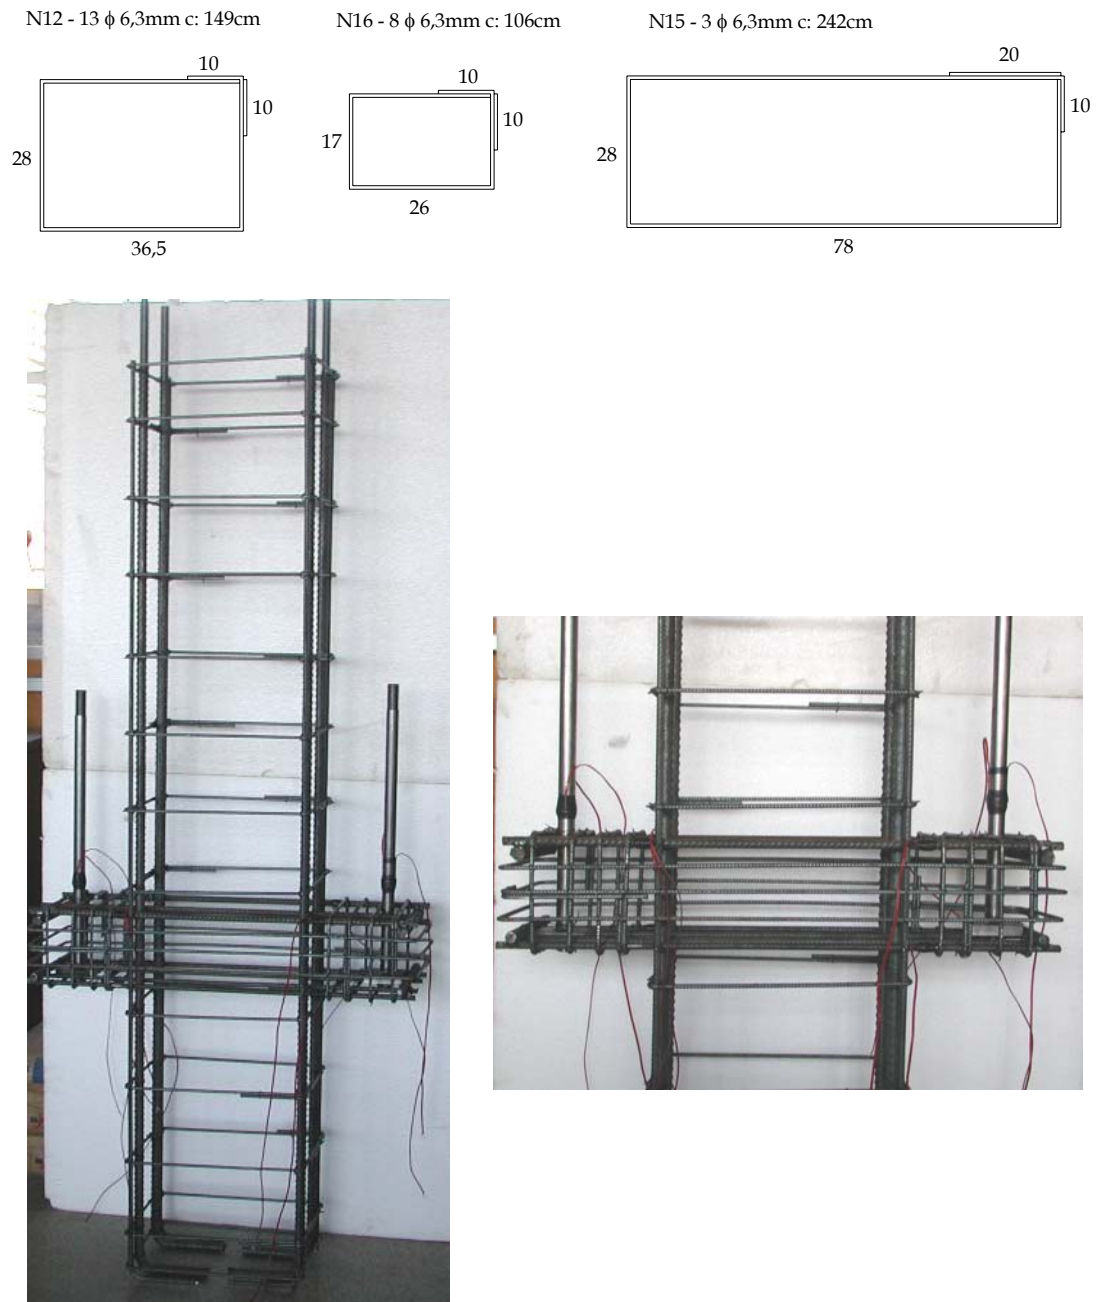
Armadura dos pilares – parte 2 (dimensões em cm).
